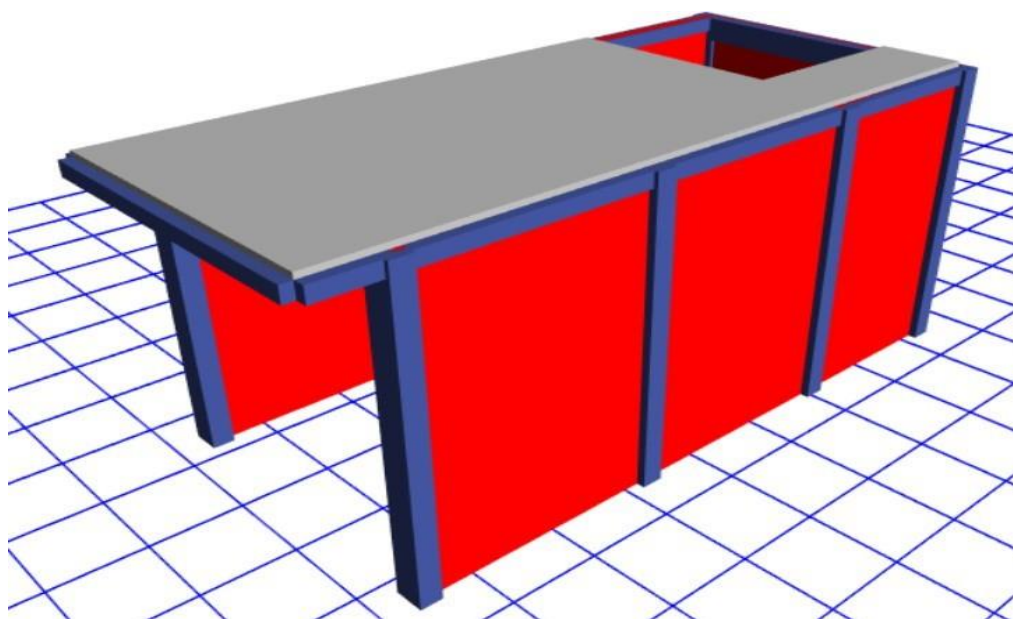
Modelamiento en Etabs- vivienda autoconstruida 3
